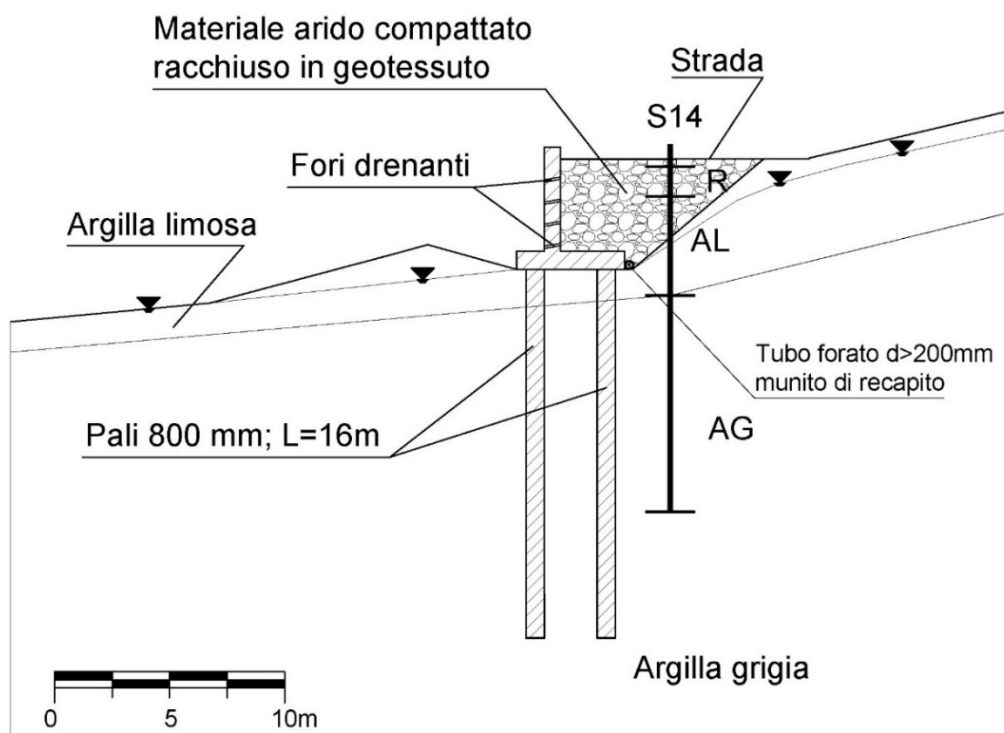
Zona Pietralunga, km 8+700. Sezione schematica A-A'.
